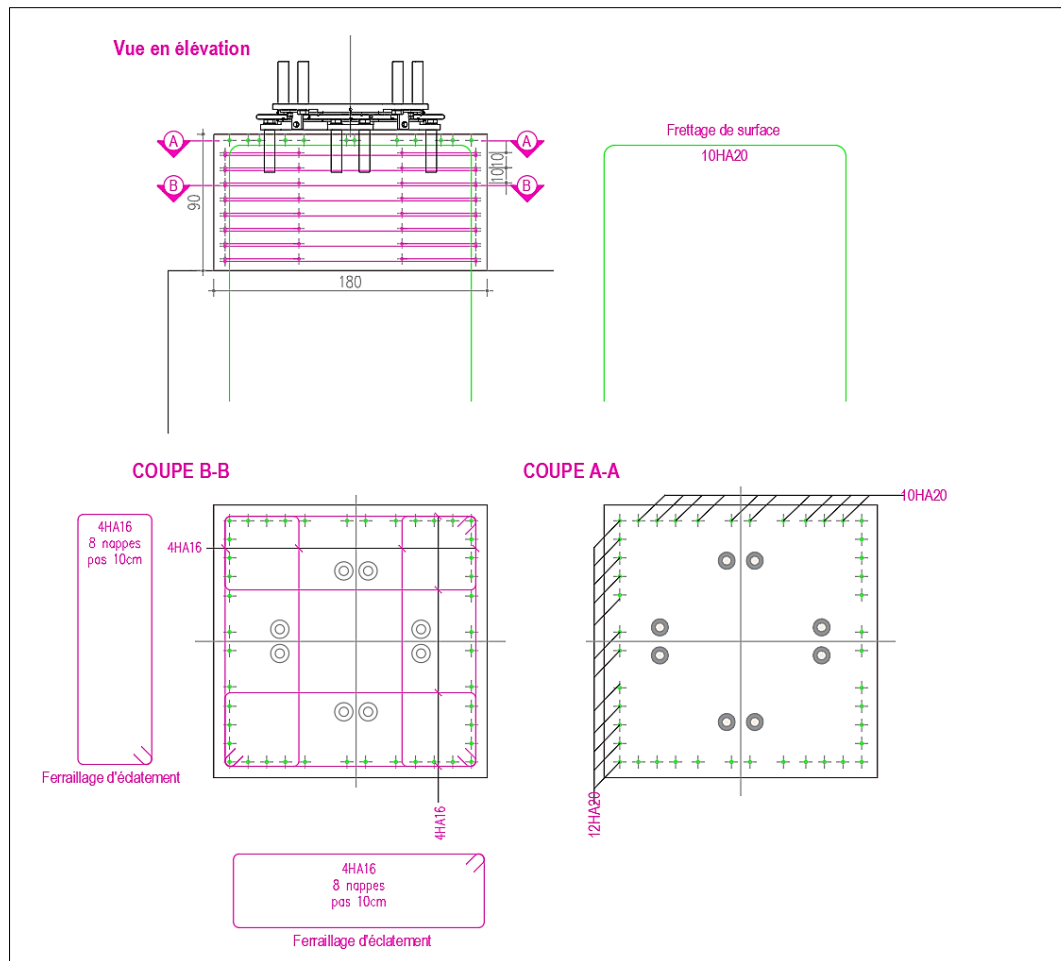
Plan de ferrailage des dés d'appui au niveau des piles
